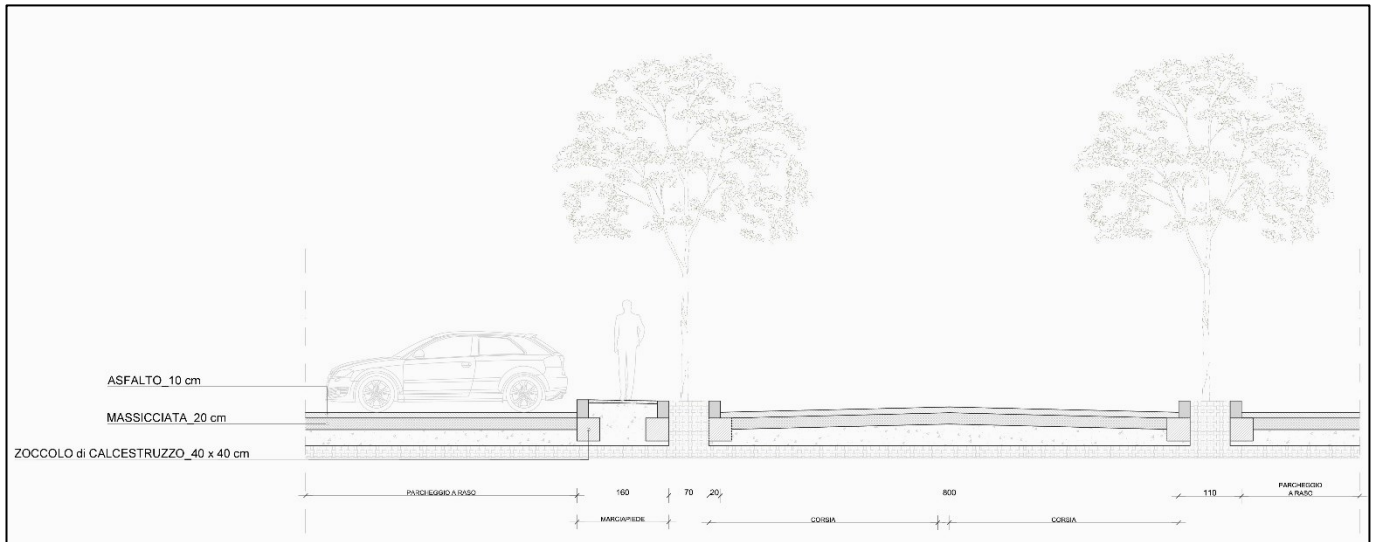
SEZIONE T.3 SUB-AMBITO B.2
